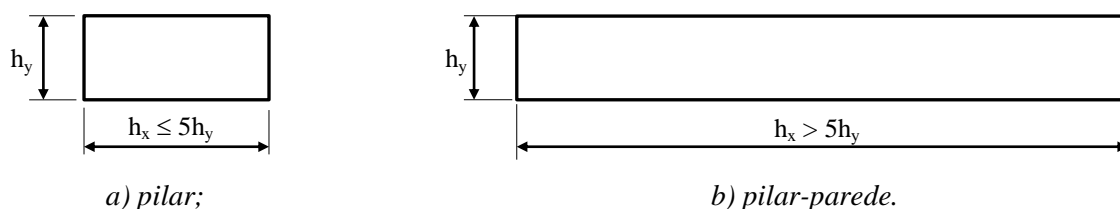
Definição de pilar e pilar-parede em função das dimensões da seção transversal.
